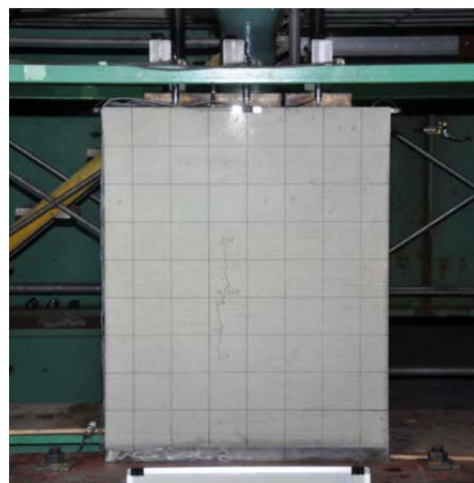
ひび割れ状況(試験体No. 5, 載荷ステップc)
